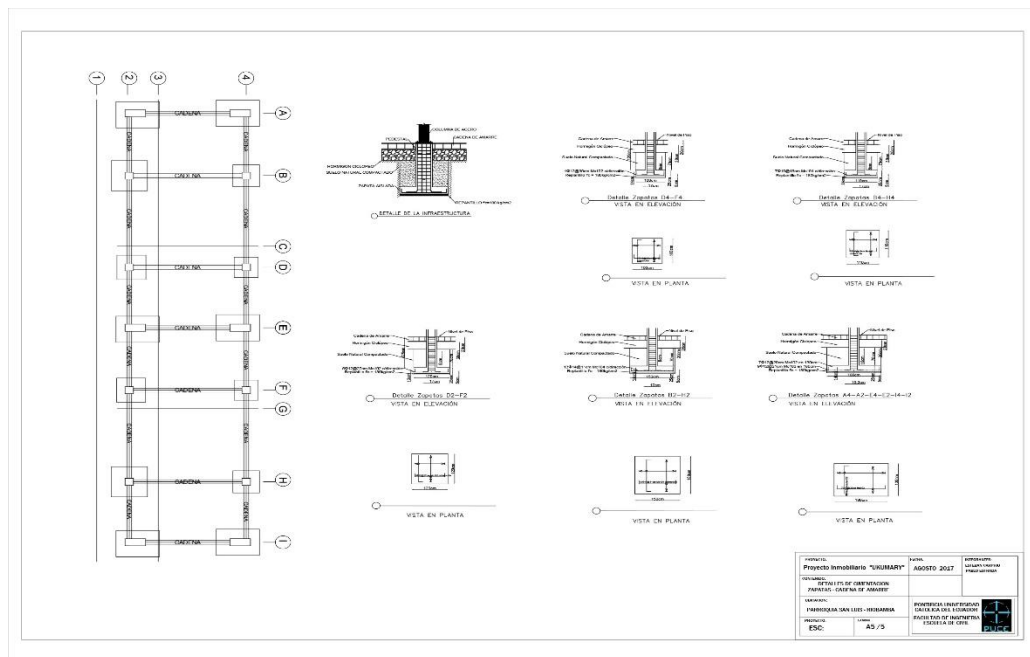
Detalle de planos estructurales - plintos – Fuente: Carphio (2017)
